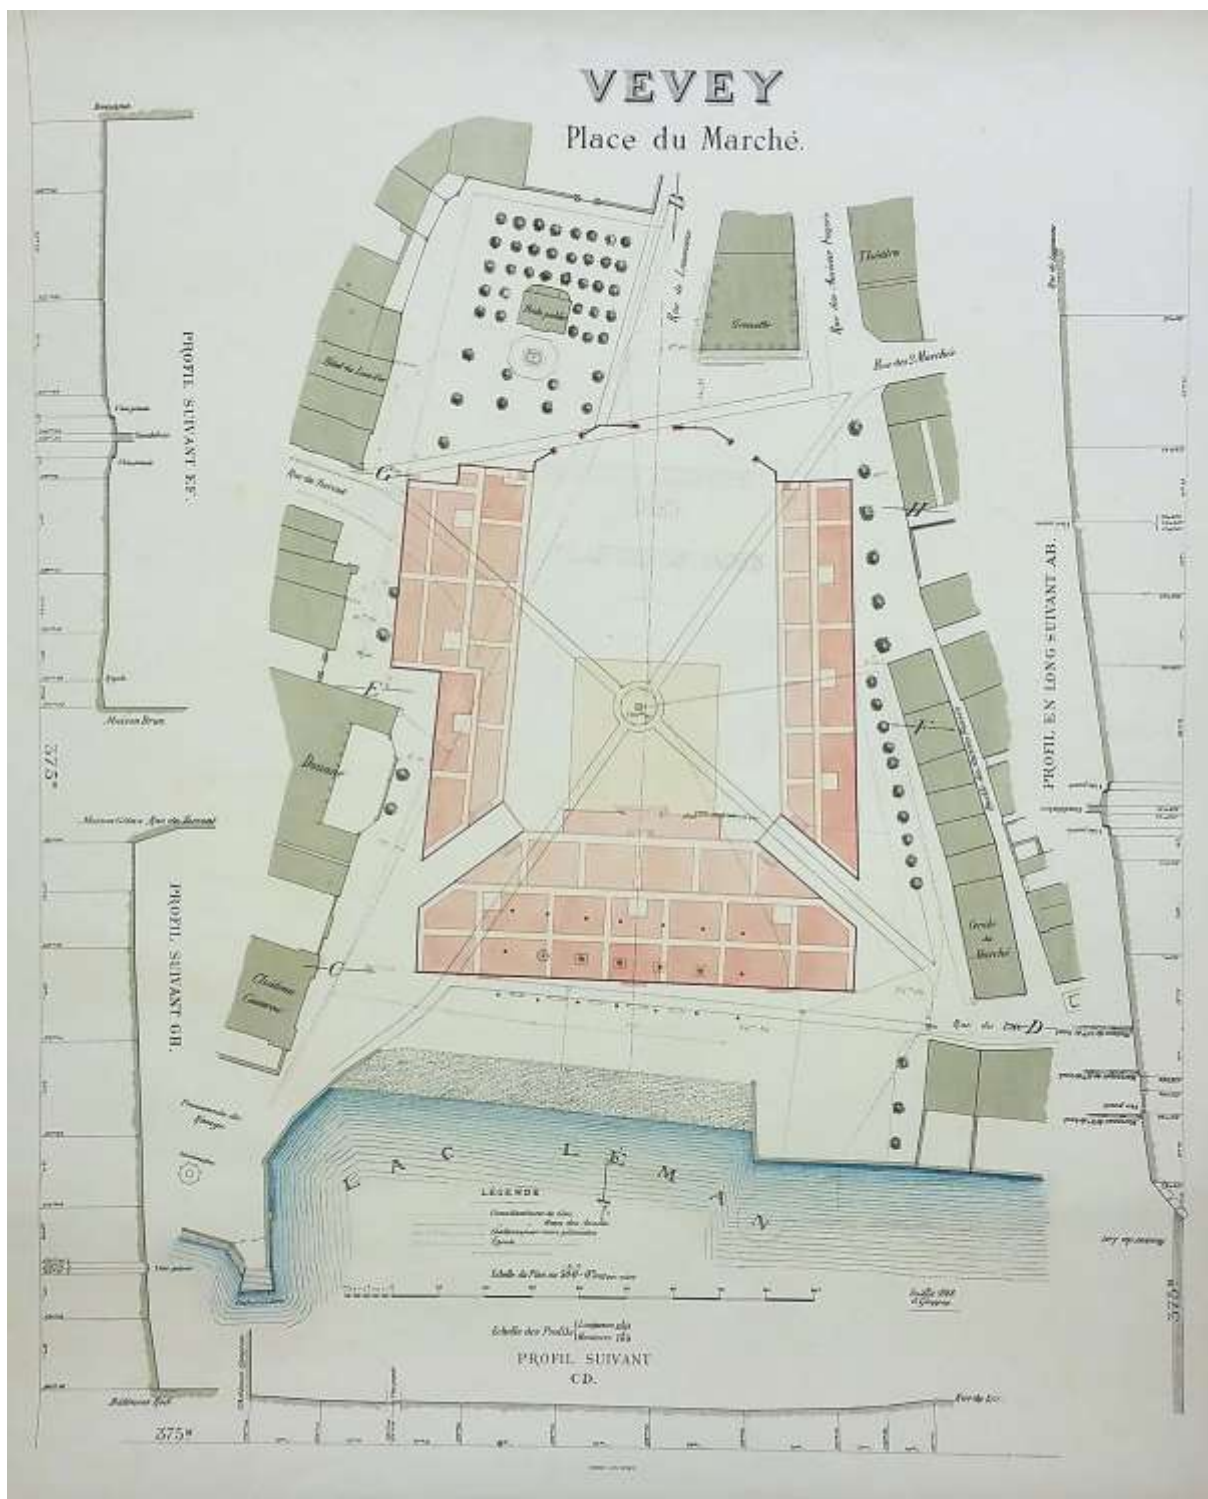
Plan des tribunes de la Fête des vigneron de 1889 (AV).
